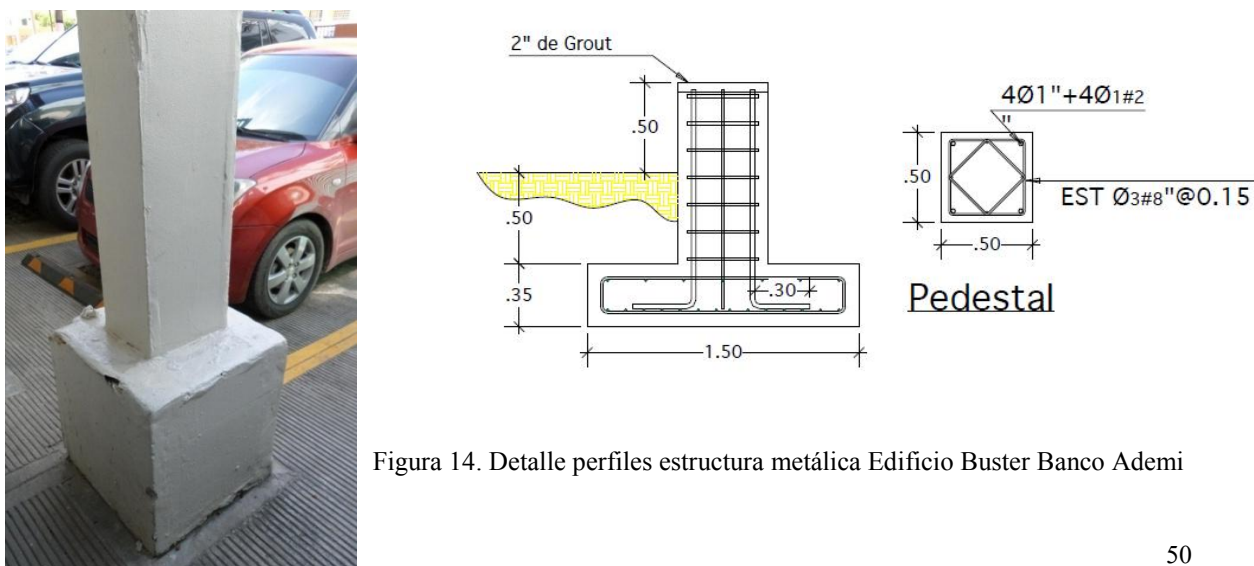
Detalle perfiles estructura metálica Edificio Buster Banco Ademi
